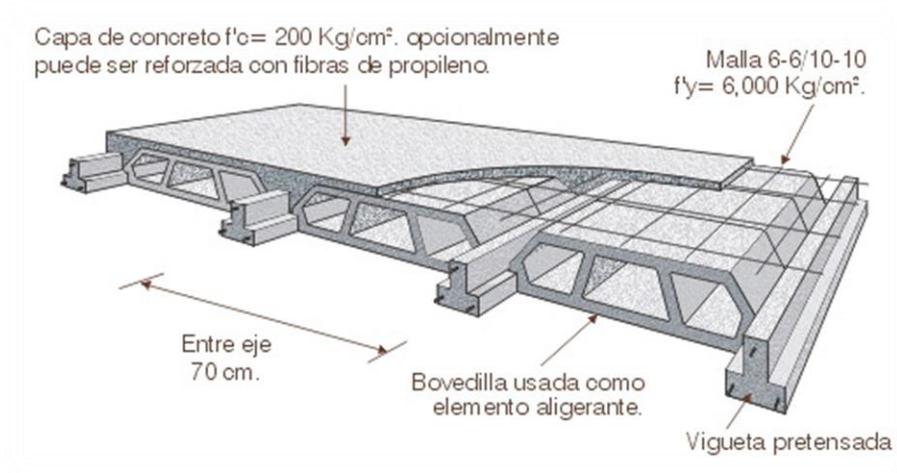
Aplicación de viguetas y bovedillas en losas prefabricada de alma abierta
